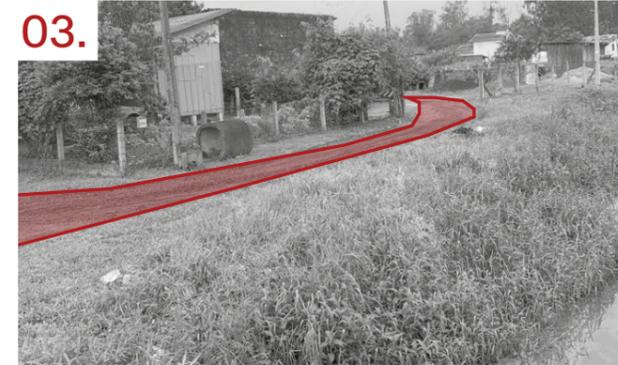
caminho não pavimentado. fonte: arquivo pessoal
